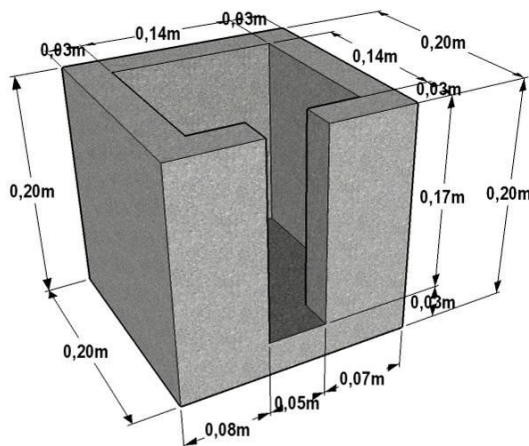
Croqui esquemático das dimensões do bloco caixa (C)
